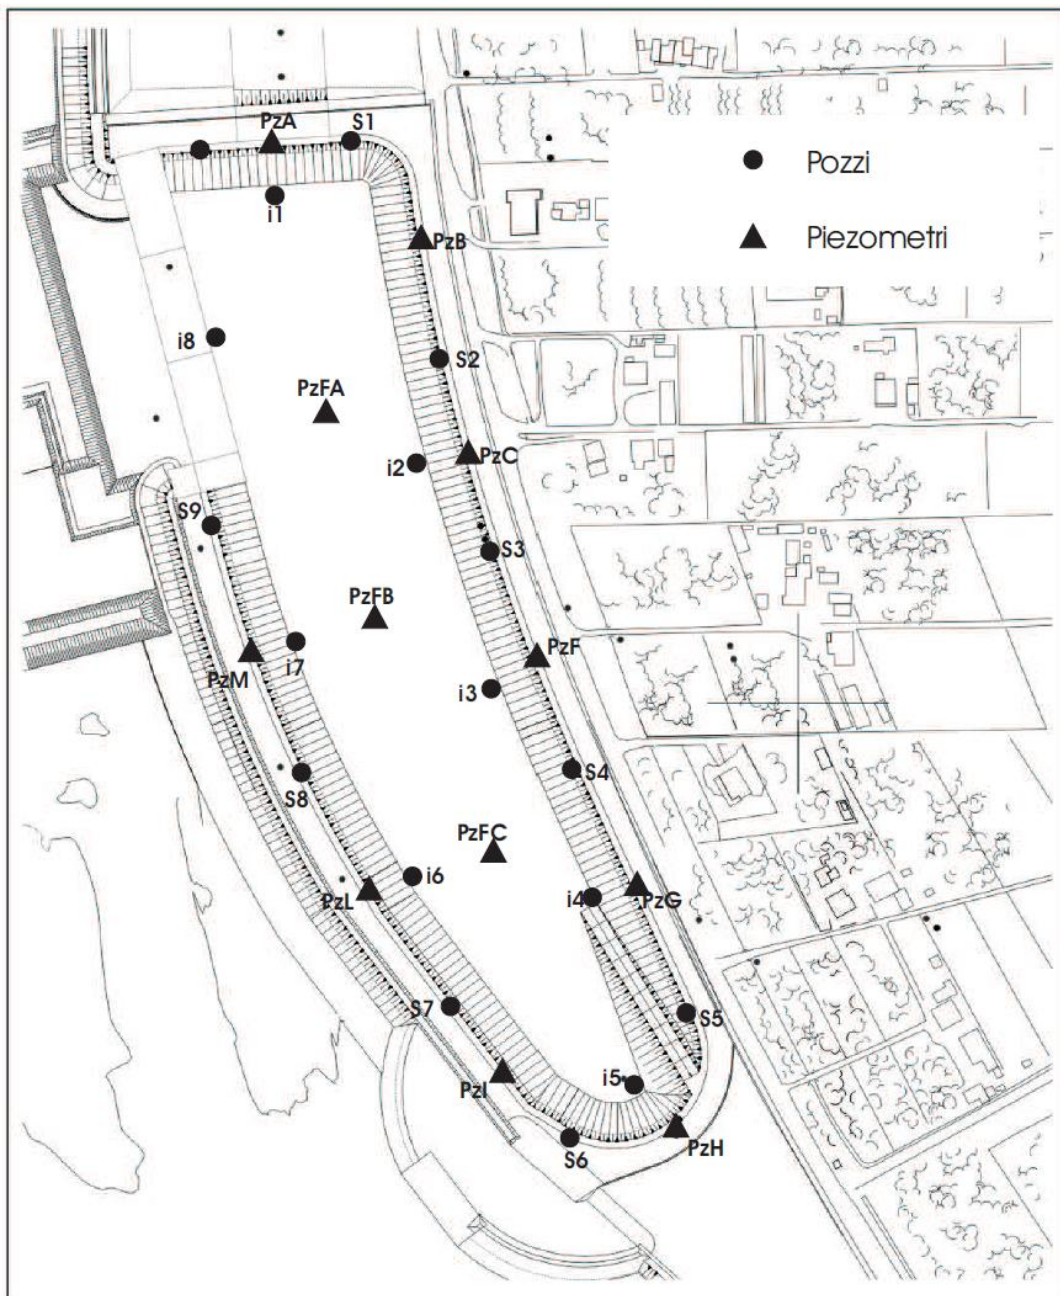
Planimetria del sistema di dewatering della tura (fonte: Consorzio Venezia Nuova).
